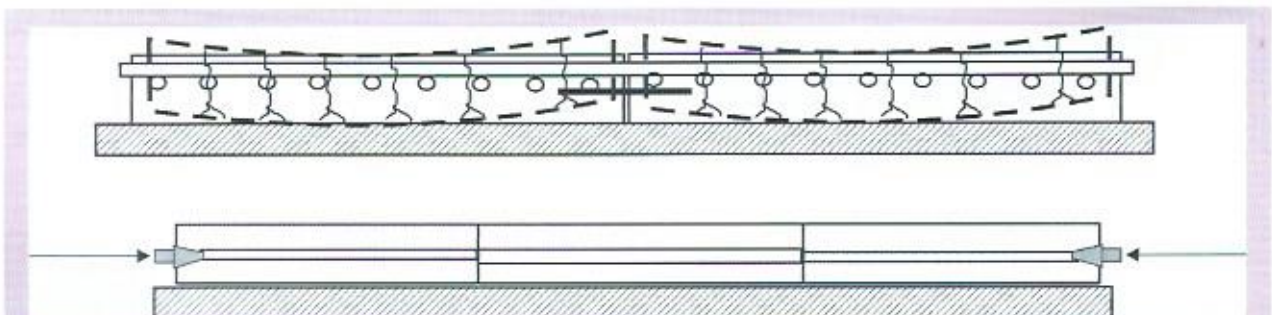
El sistema postensado comprime el radier y provee resistencia a la deflexión y fisuras del pavimento; también controla el alabeo en los bordes.
